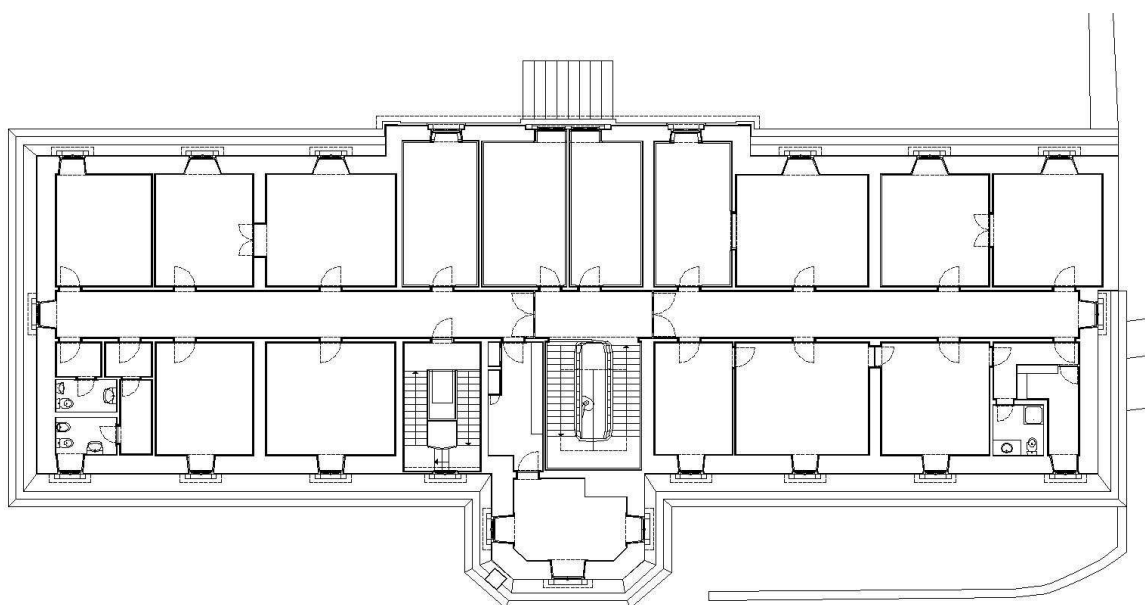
Planta do Piso 2 (Piso de mansarda).
